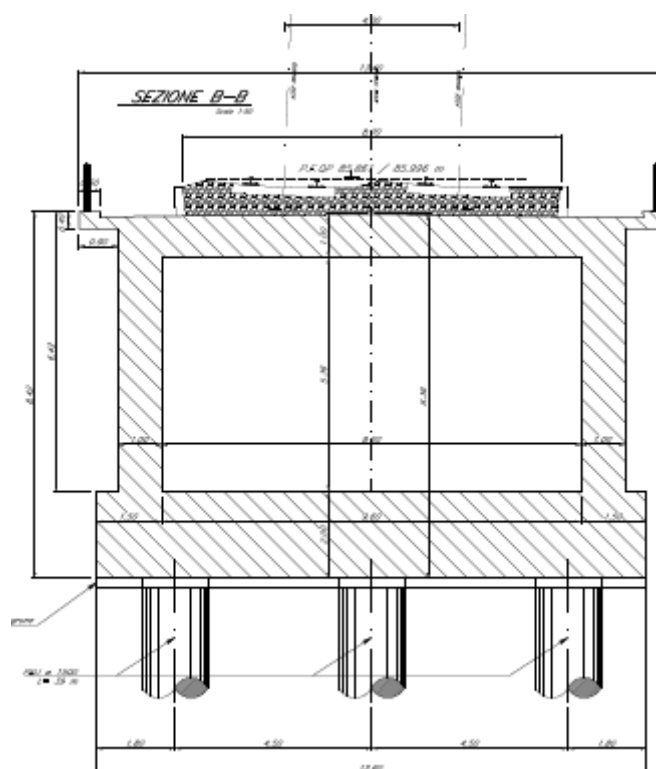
Sezione B-B spalla Ponte sul Naviglio Pavese
